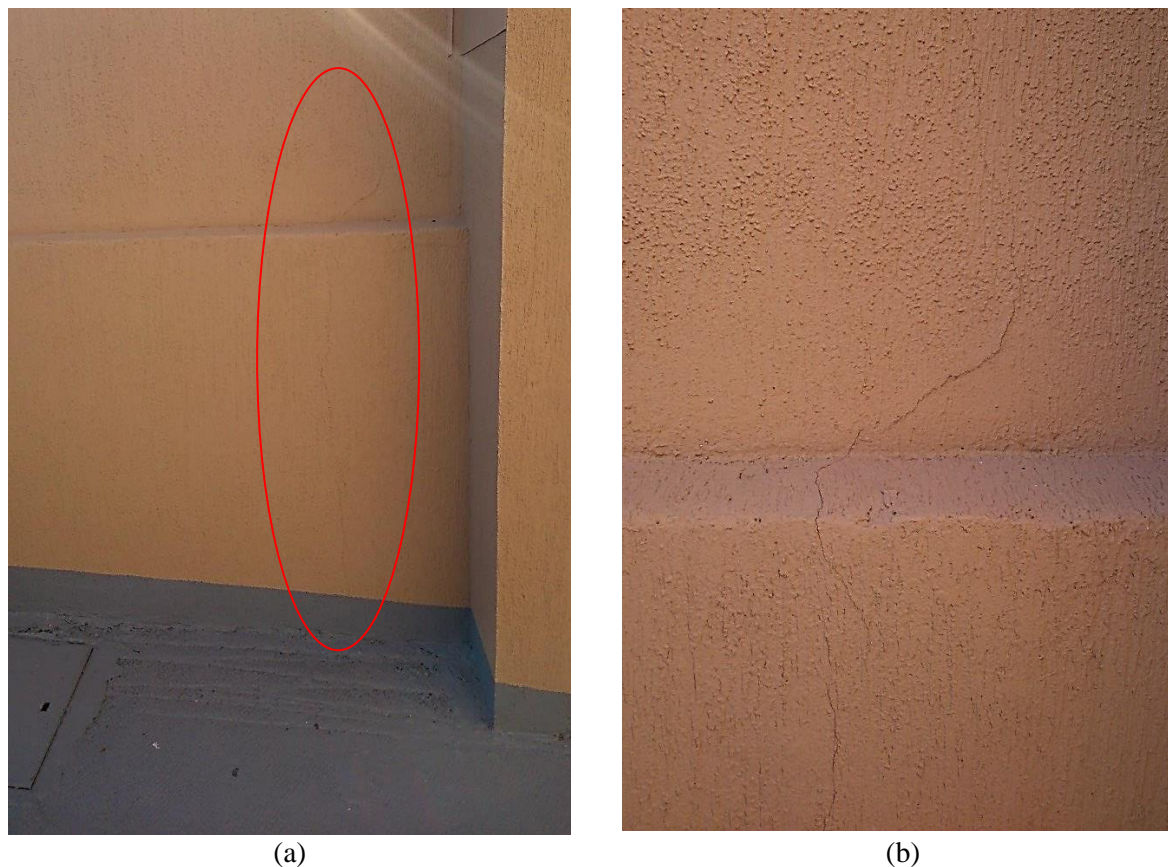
(a) parede do terraço apresenta fissura longitudinal e
